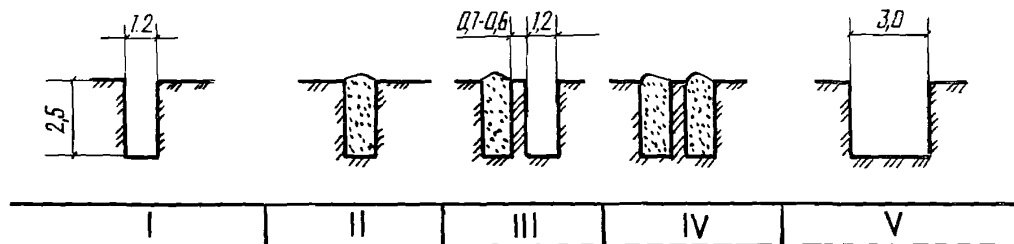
Технологическая схема разработки траншей в вечно-мерзлых грунтах для прокладки пригружаемых трубопроводов диаметром 1020-1420 мм на участках глубиной от 2,2 до 2,5 м:
